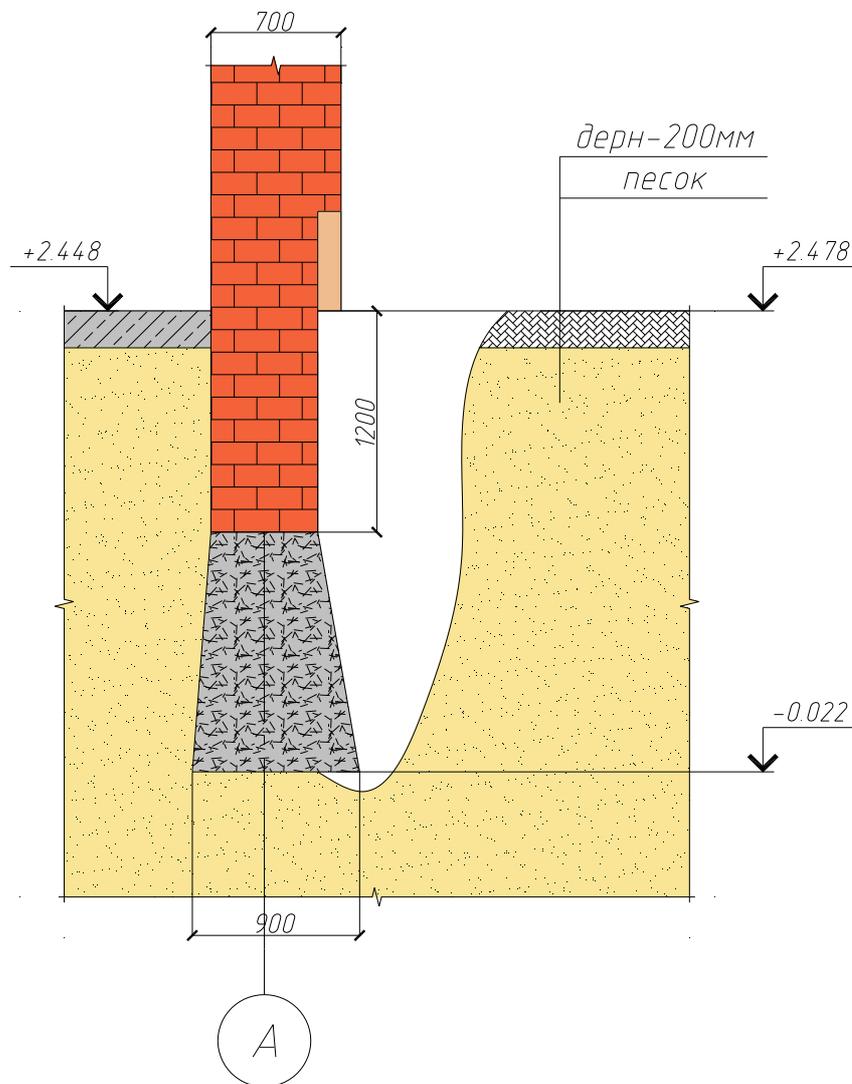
Эскиз поперечного сечения фундамента.
